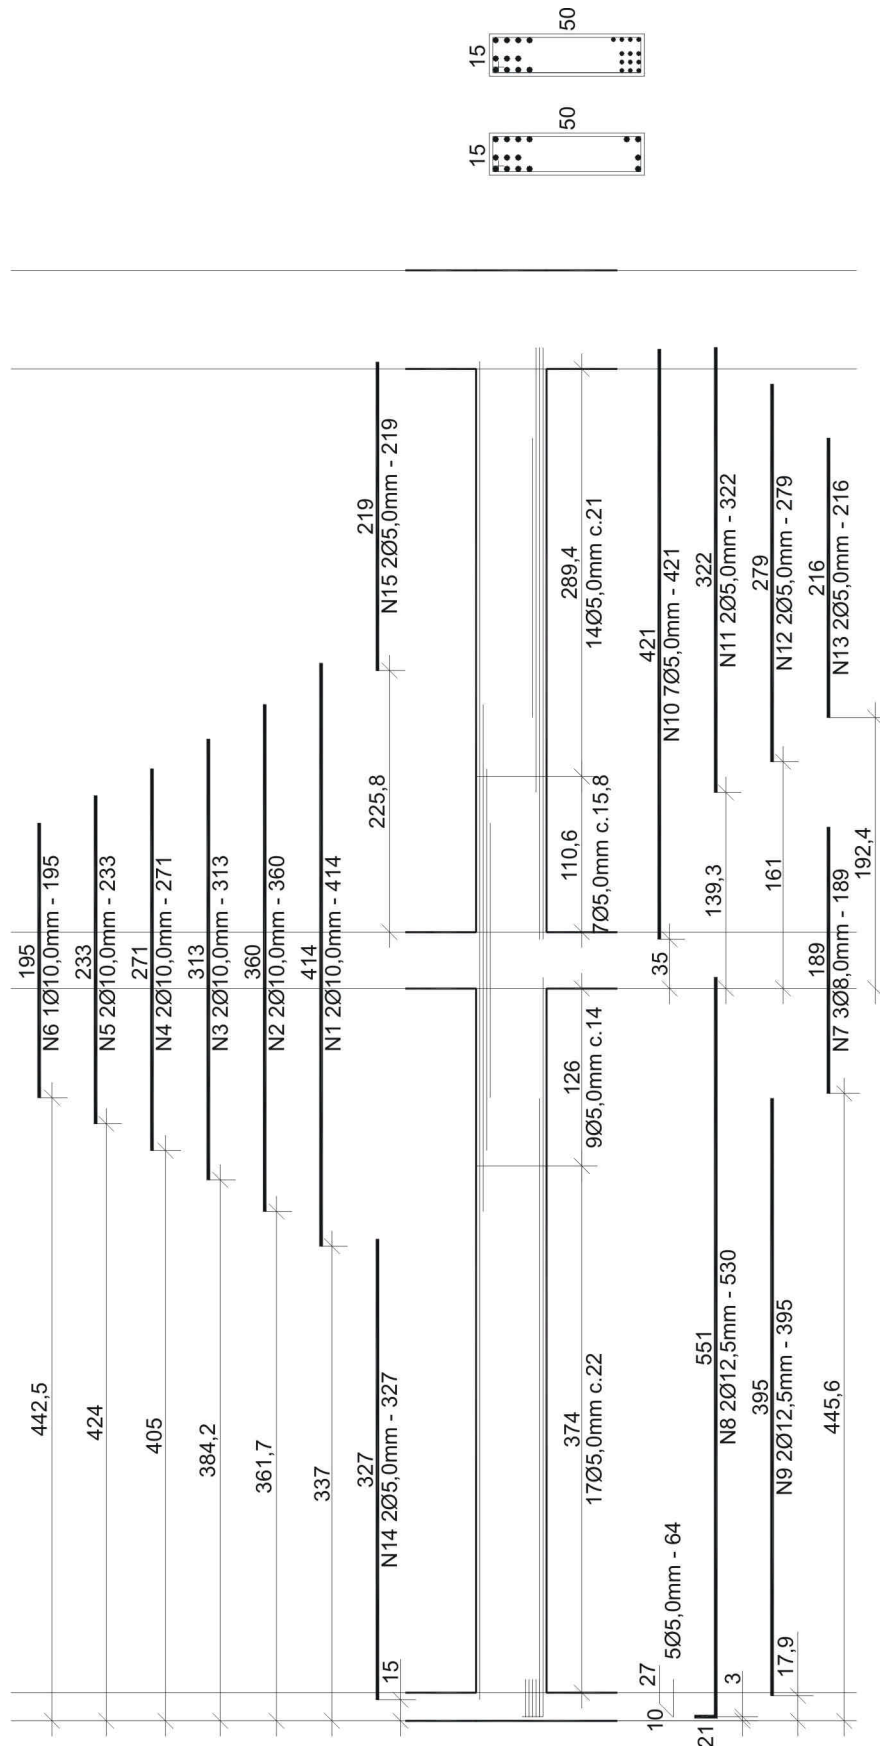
Detalhamento Viga 03.1, realizado pelo VigaCalc.
